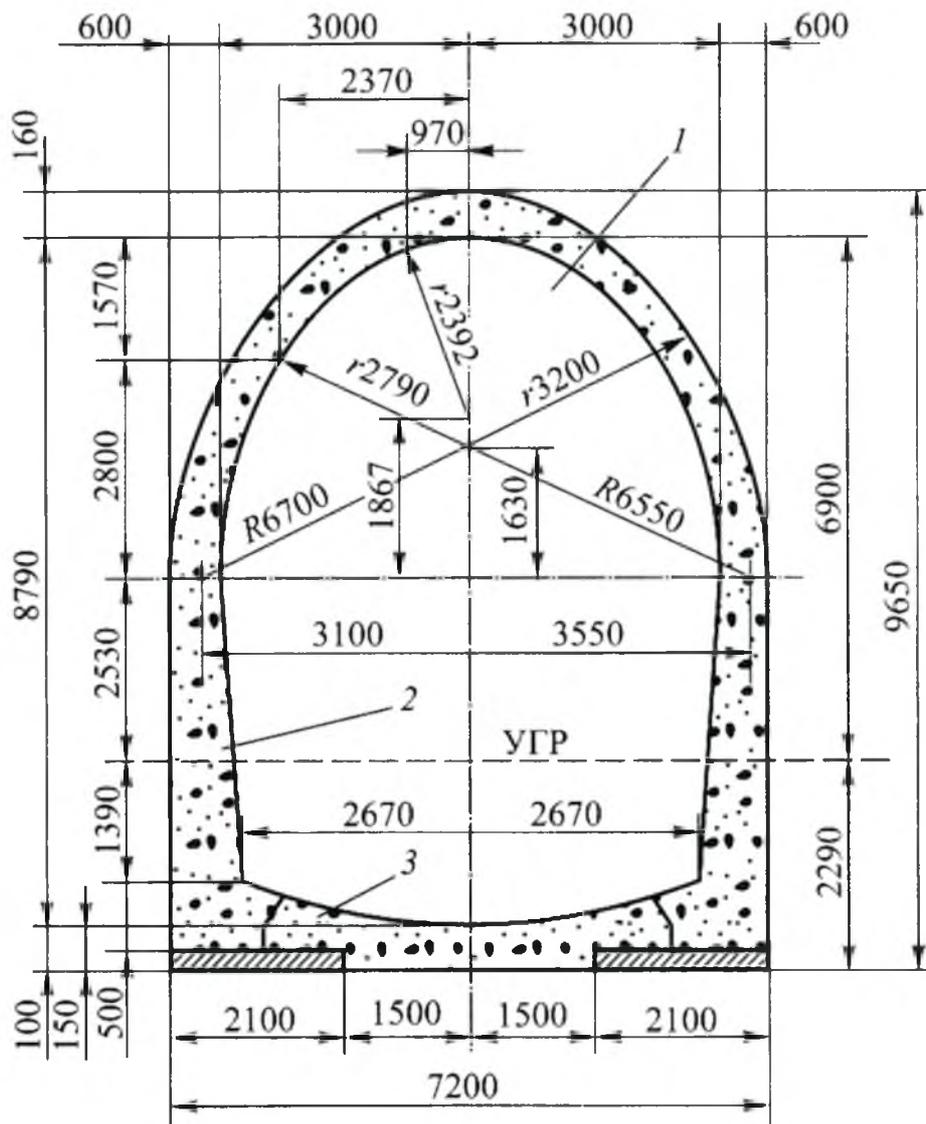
Конструкция монолитной бетонной обделки с обратным сводом (давление грунта вертикальное и боковое):
